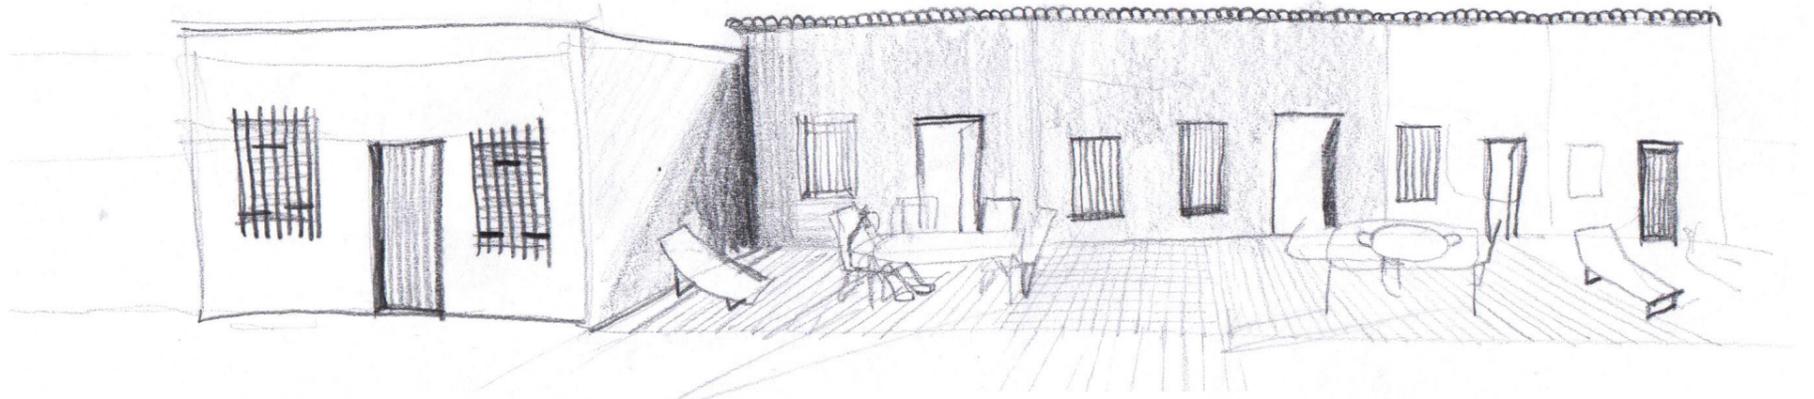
Los pajares de la Calle Paz, por el alzado Norte. Fuente: Elaboración propia.
